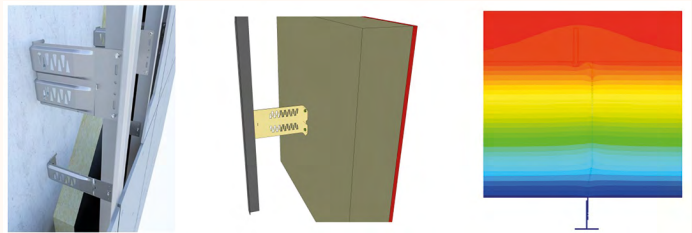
Imagen, modelo de cálculo 3D y mapa de isoterma del certificado Passivhaus del sistema de anclaje de fachada ventilada FLH R de Fisher.
